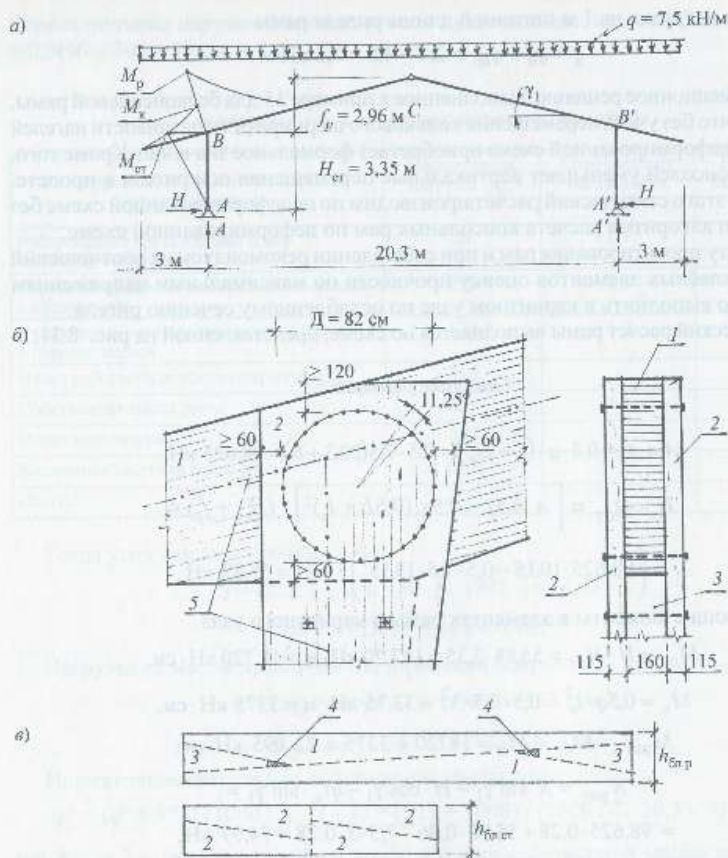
Двухконсольная рама: а – расчетная схема; б – жесткий узел на нагелях, установленных по окружности; в – схемы заготовочных блоков: 1 – полуригель; 2 – ветвь стойки; 3 – шрокладка; 4 – отходы; 5 – оси расчетной схемы
